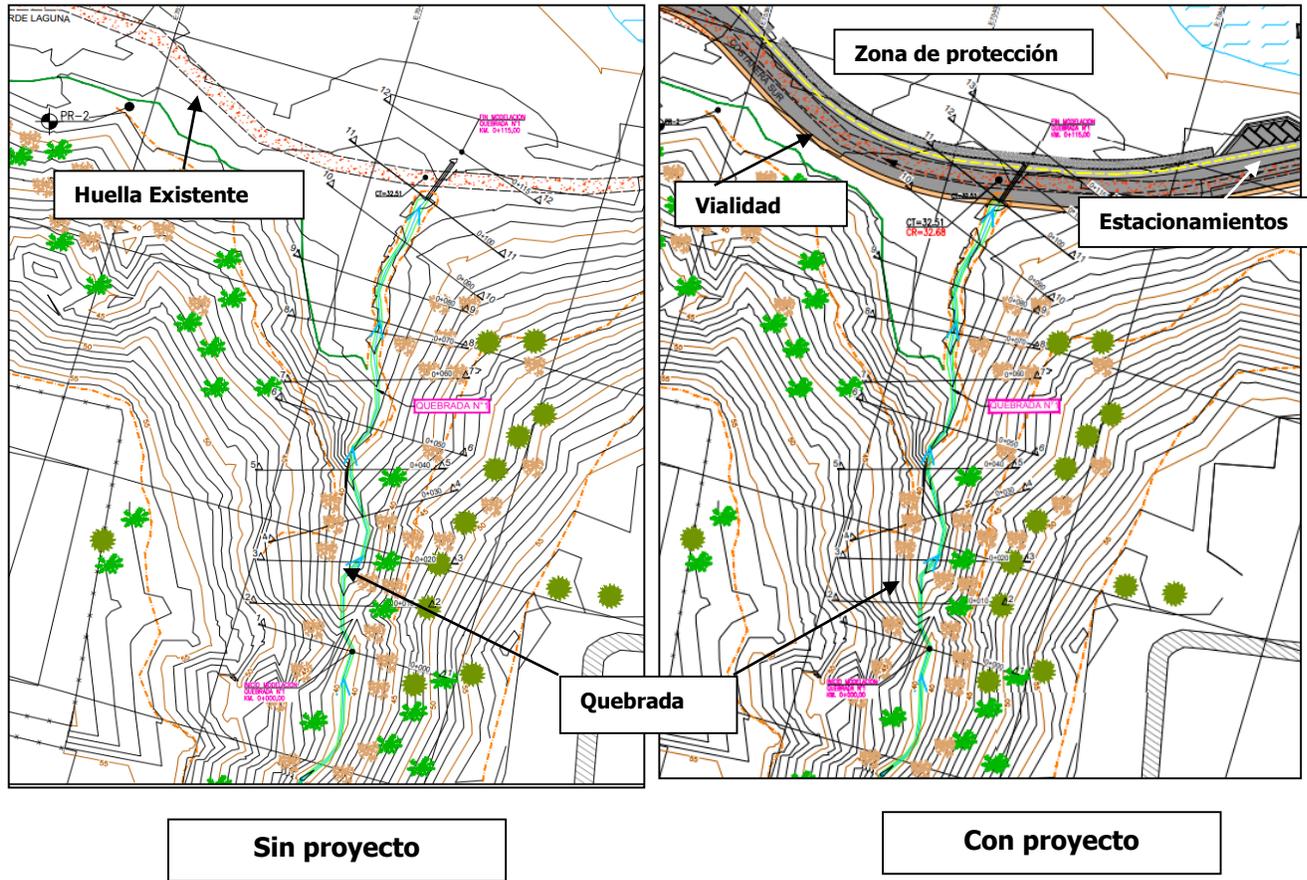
Detalle Quebrada 1 con y sin proyecto ZPdr
